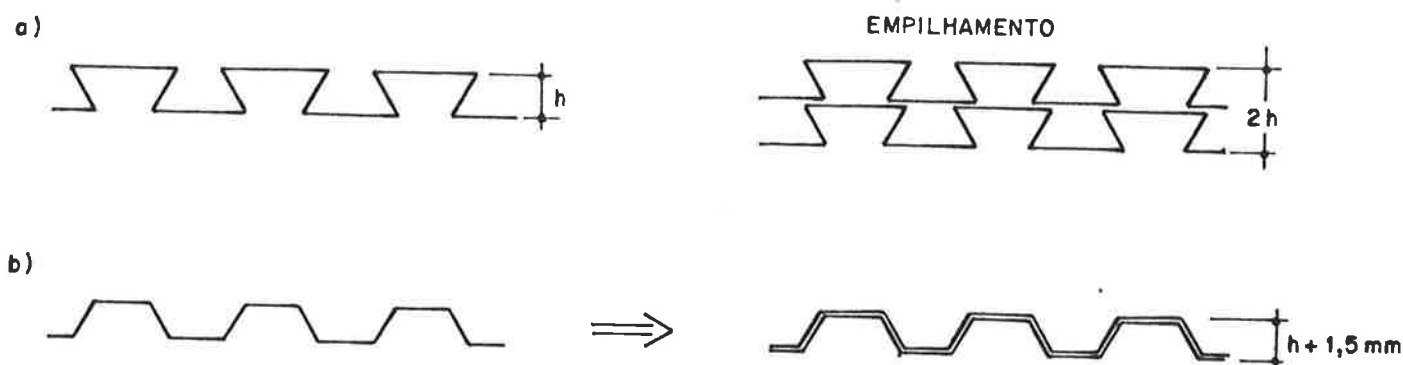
Empilhamento de perfis: a) rabo-de-andorinha; b) trapezoidal.
